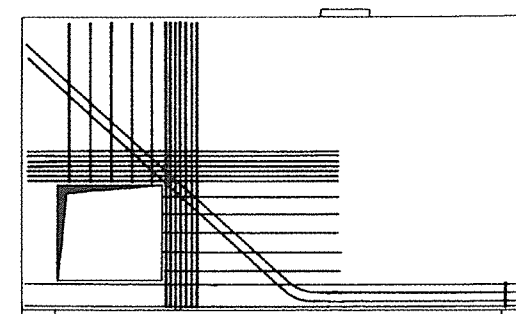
Disposition des armatures principales de la poutre-voile (sans le treillis des armatures secondaires) [7].
